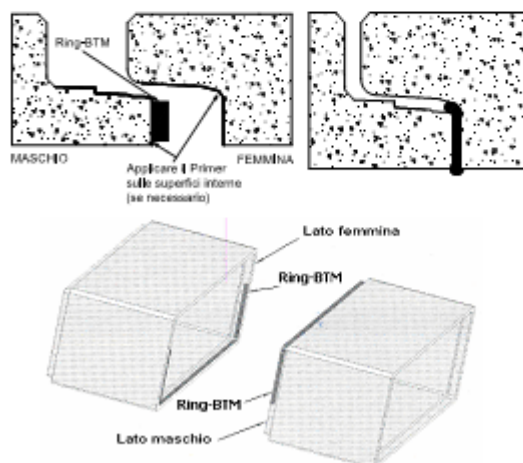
H : Specifica tecnica pozzo autoaffondante rettangolare
